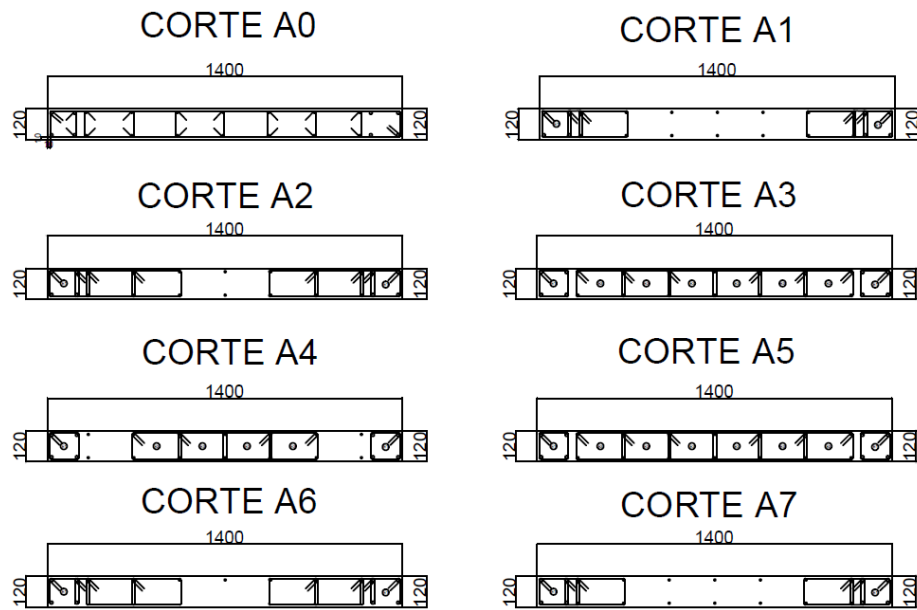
Vista de cortes en plano de muro alternativo.
